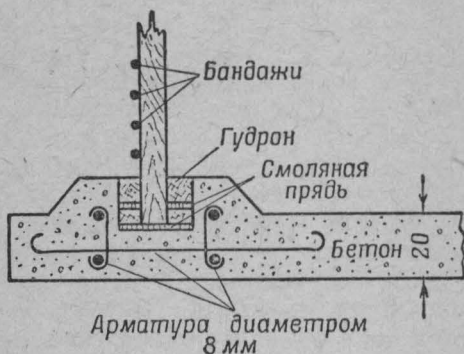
Сопряжение стенок деревянного водоема с бетонным днищем
